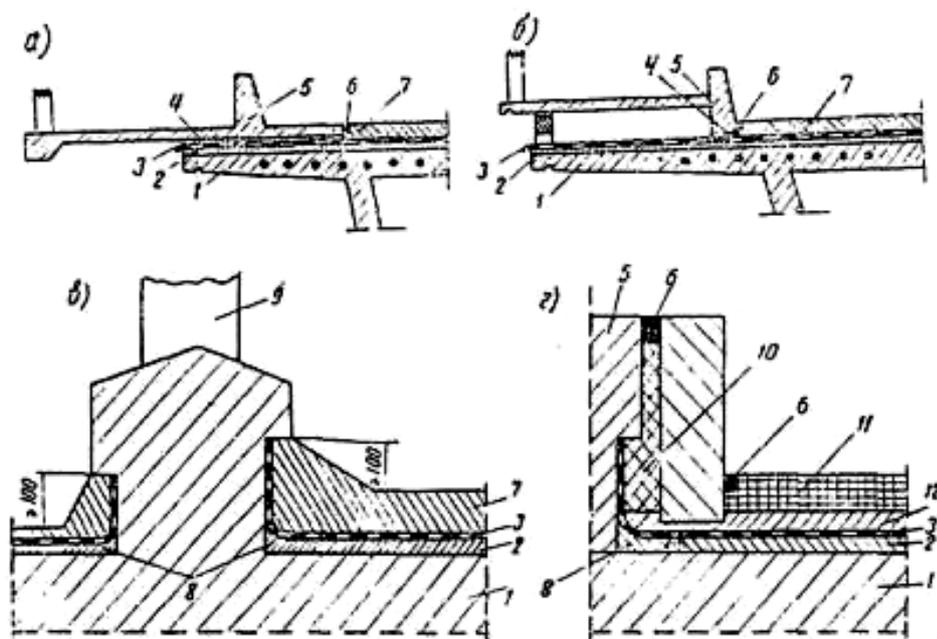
Схемы сопряжения оклеенной гидроизоляции с элементами мостового полотна:
